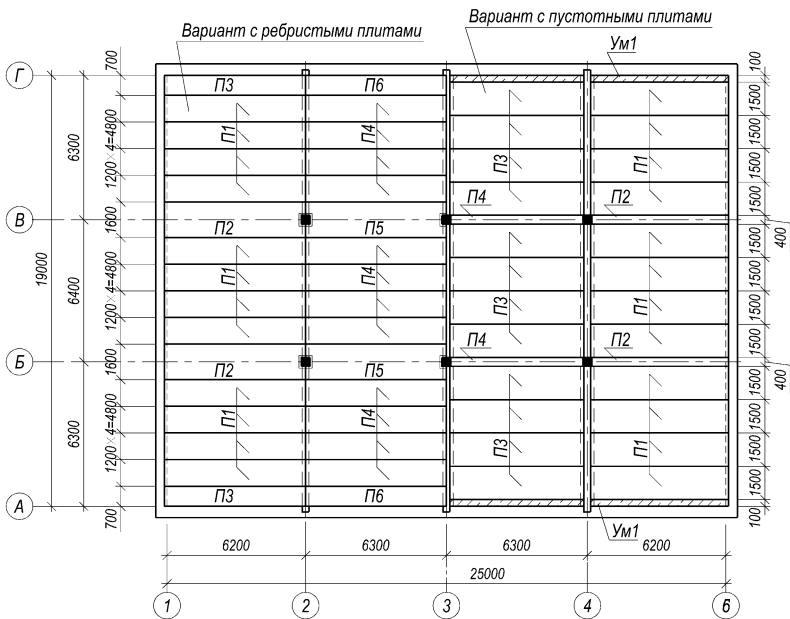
Схема перекрытия с поперечным расположением ригелей
